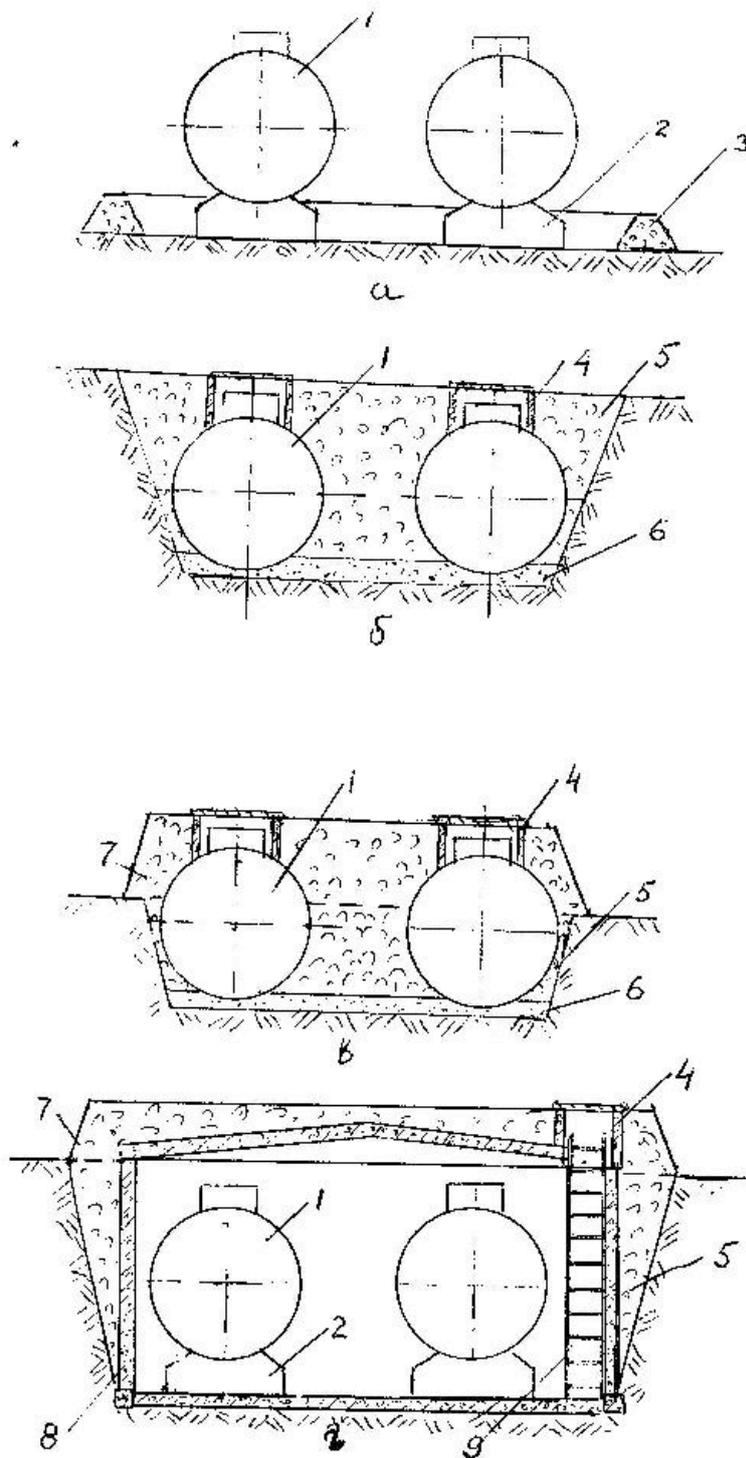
Схемы установки резервуаров на объекте: а - наземная; б- заглубленная; в- частично- заглубленная с обсыпкой грунтом; г- наземная: 1- резервуар; 2- опора; 3- обвалования; 4- колодец; 5- котлован; 6- песчаная подушка; 7- насыпь; 8- каземат; 9- лестница.
